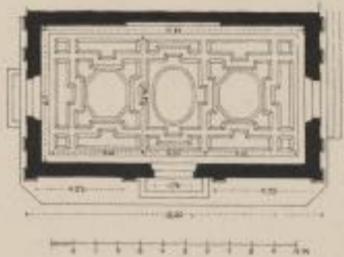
GRUNDRISS DER KIRCHE MADONNA DI PIÈ DELLA PIAZZA.
